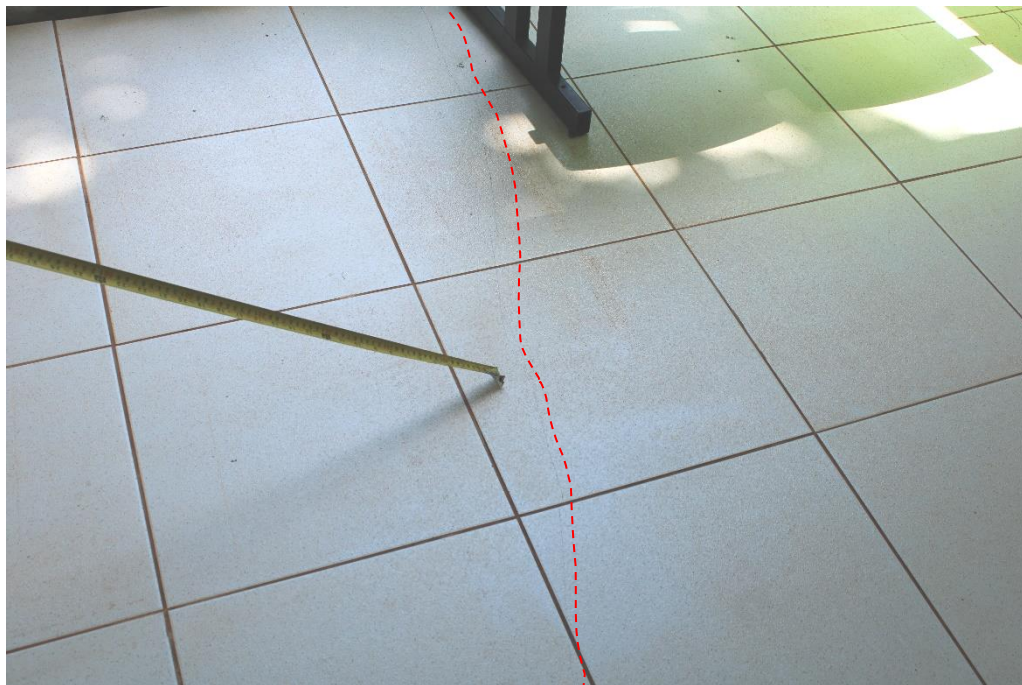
Em detalhe a Foto supra, destacando fissura no revestimento cerâmico (piso).
